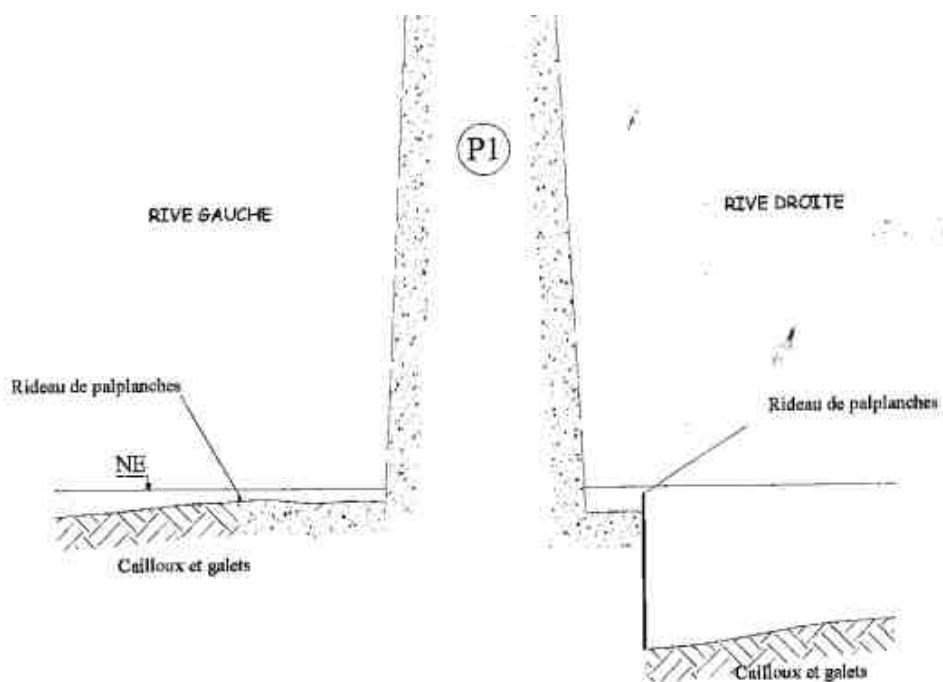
Coupe AA de la pile 1 (CG, 2008)
